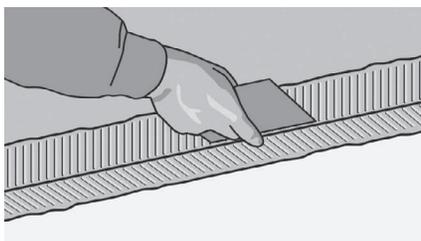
Используя прямой угол и карандаш, нанесите отметки на высоте 10 см по всей стене, где будет укладываться покрытие. Нанесите клей с помощью мелкозубчатого шпателя по всему периметру от низа стены до отмеченной линии там, где будет укладываться напольное покрытие. Нанесите некоторое количество клея на пол, как показано на рисунке.
